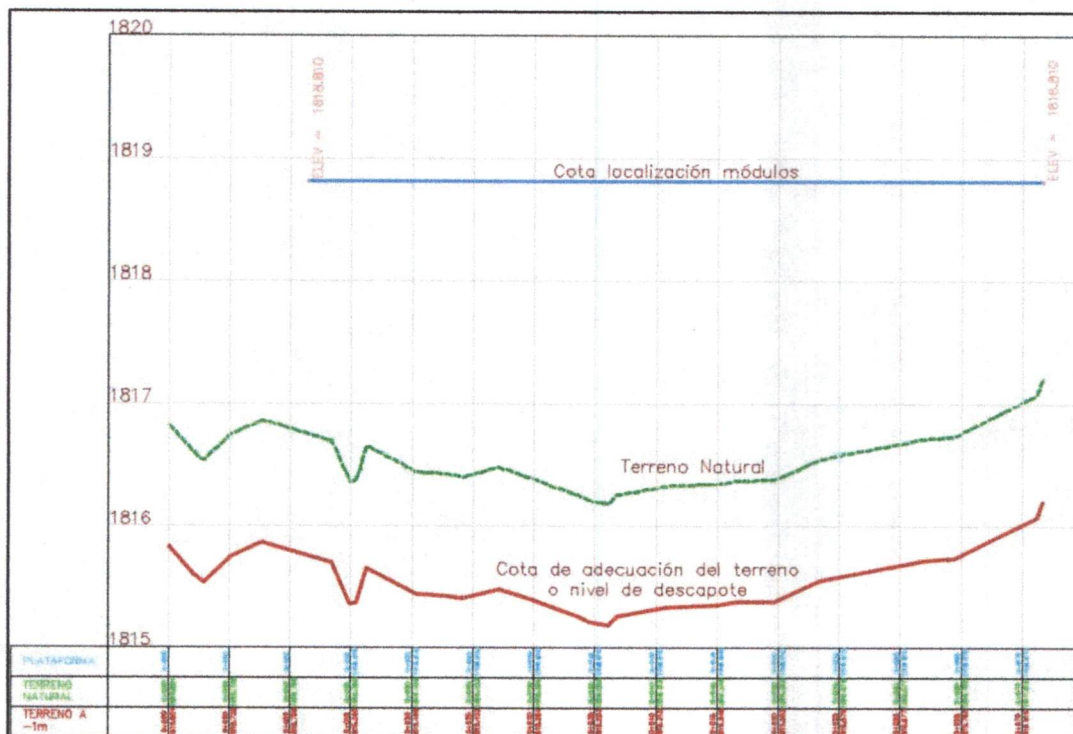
Perfiles del terreno e implantación de los módulos Fuente: El Interesado
